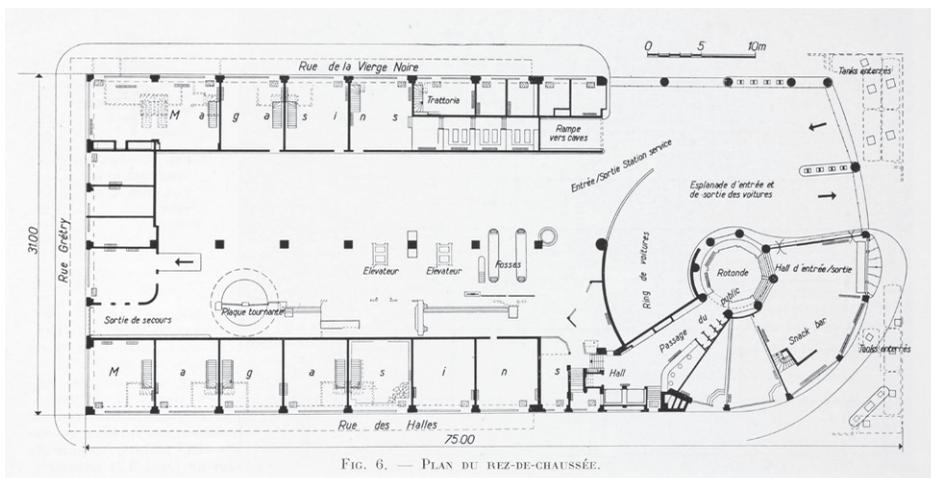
PLAN DU REZ-DE-CHAUSSÉE.
